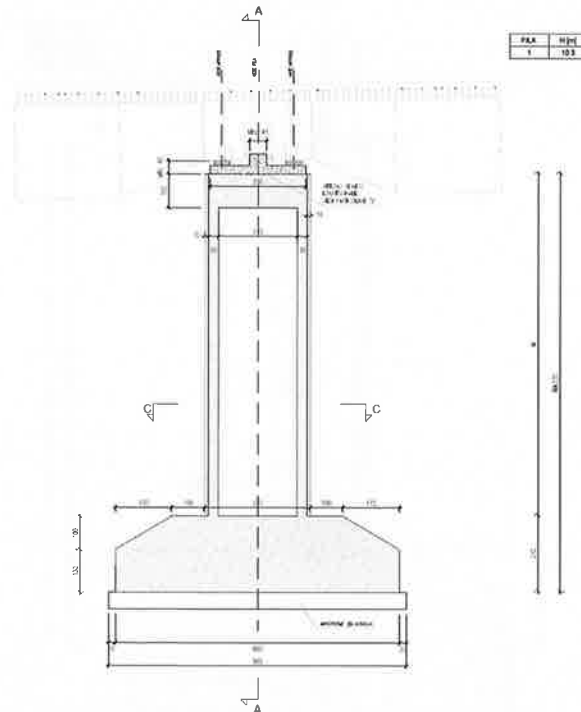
Sezione longitudinale pila H < 11m, Bonorva VI01
